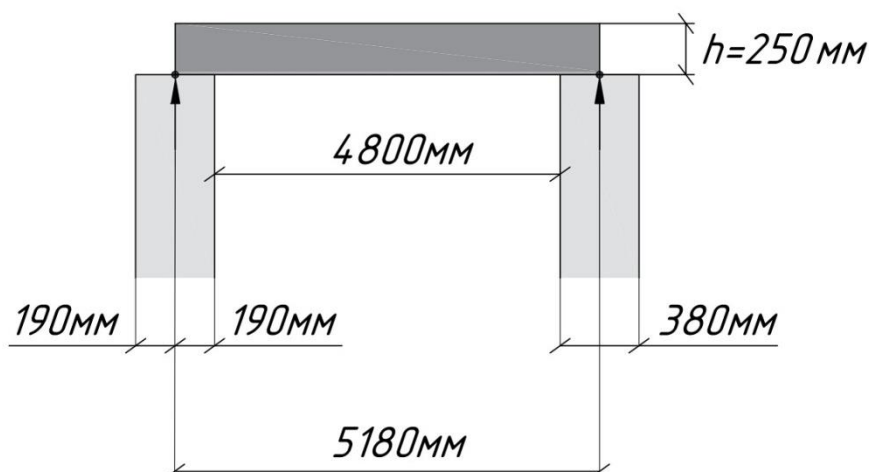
Монолитная железобетонная плита с опиранием по двум сторонам
